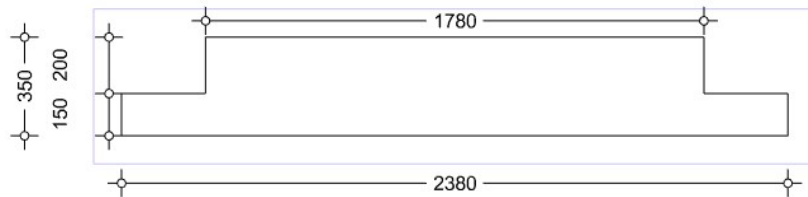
Tipikal Model *Redesign Half Slab* Tipe – 1C
